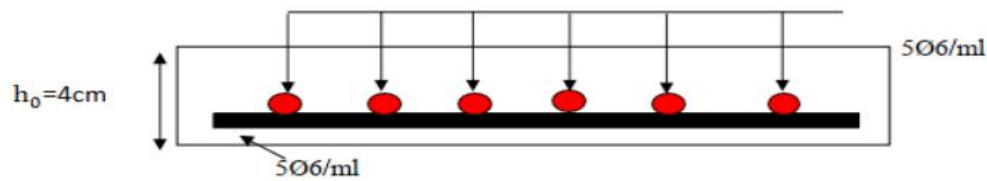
Schéma de ferrailage de la dalle de compression.
